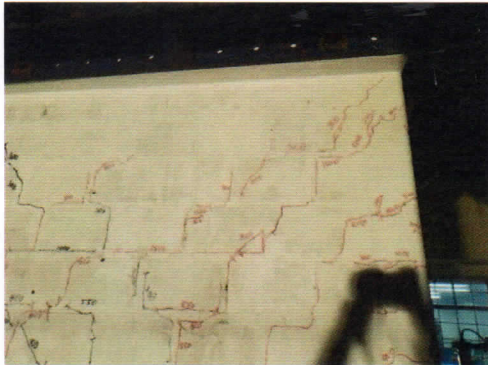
Continuación de grietas diagonales hacia la esquina superior del muro para la distorsión 1/300 Vista cara Sur.
